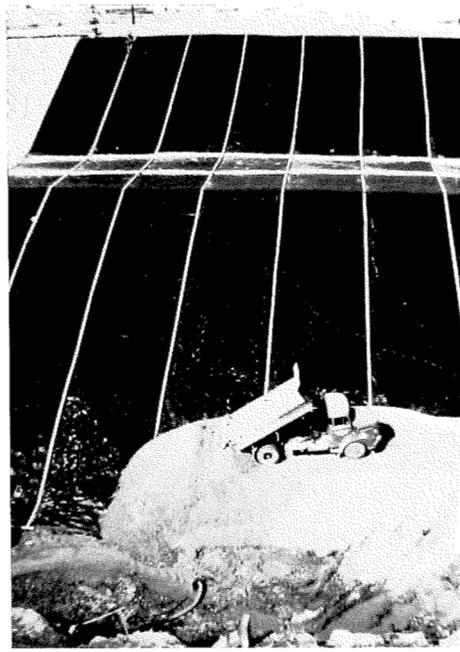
Foliendichtung im Rückstaudamm und bei Baugrubenumschließungen
